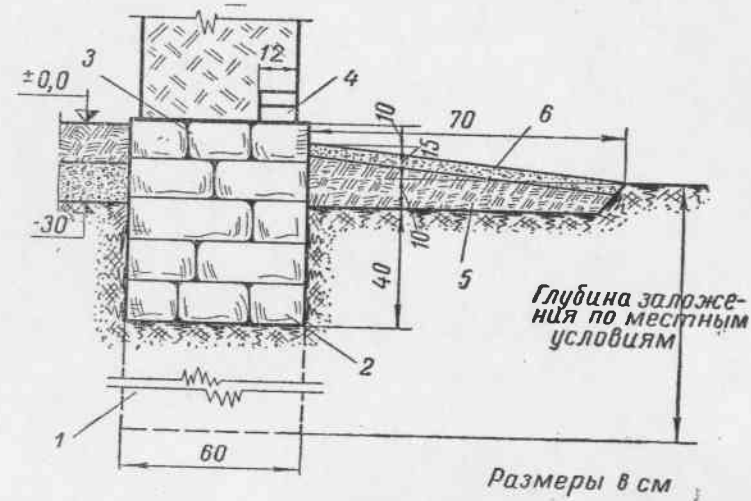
Устройство гидроизоляции и отмостки при саманных стенах: 1—бутовый фундаментный столб; 2—забирка из бутового камня; 3—гидроизоляция (2 слоя толя); 4—два ряда кирпича; 5—утрамбованная глина; 6—утрамбованный щебень.
